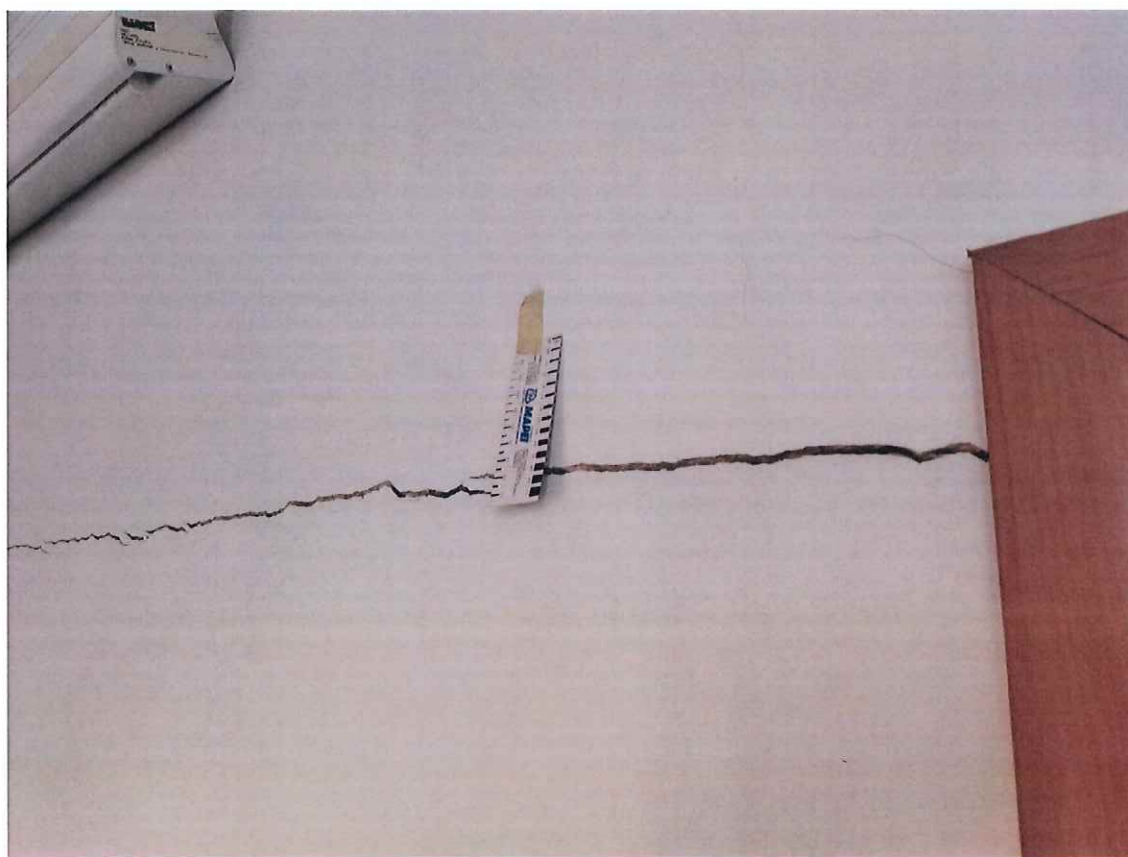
Zarysowanie ścian pomieszczenia P212 od strony korytarza (rysa 1,3 mm)
